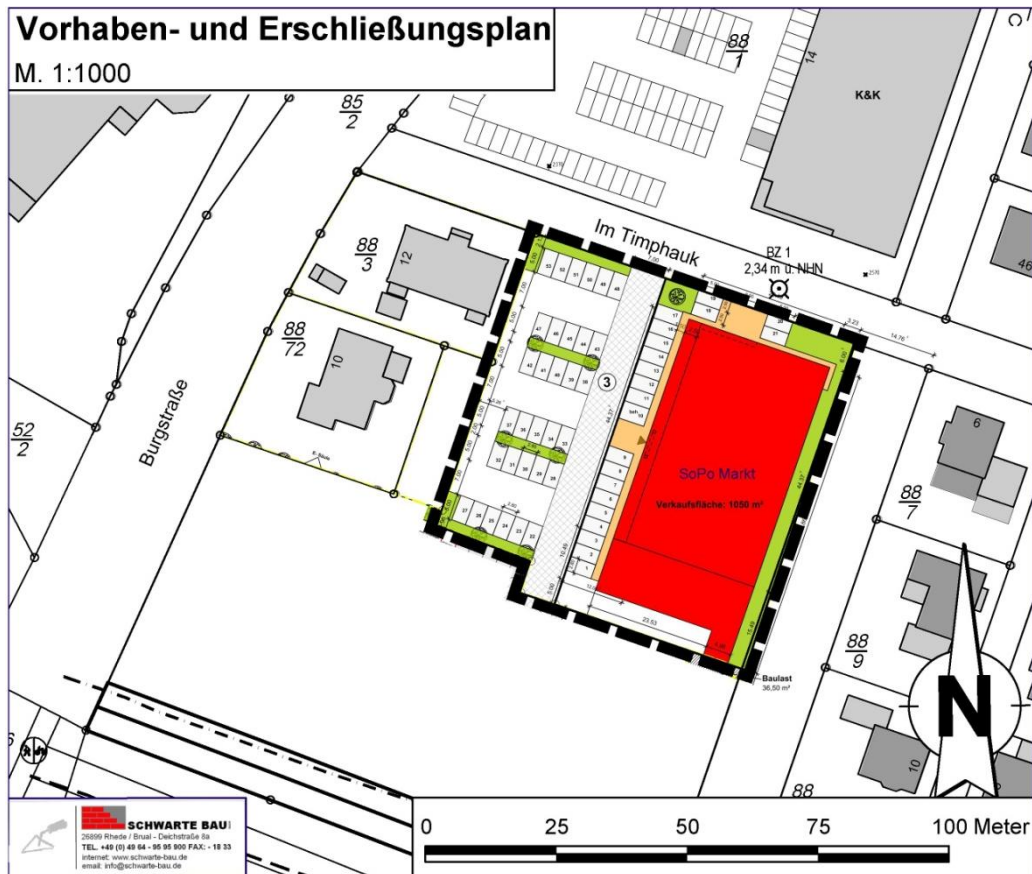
Vorhaben und Erschließungsplan (V+E - Plan)
